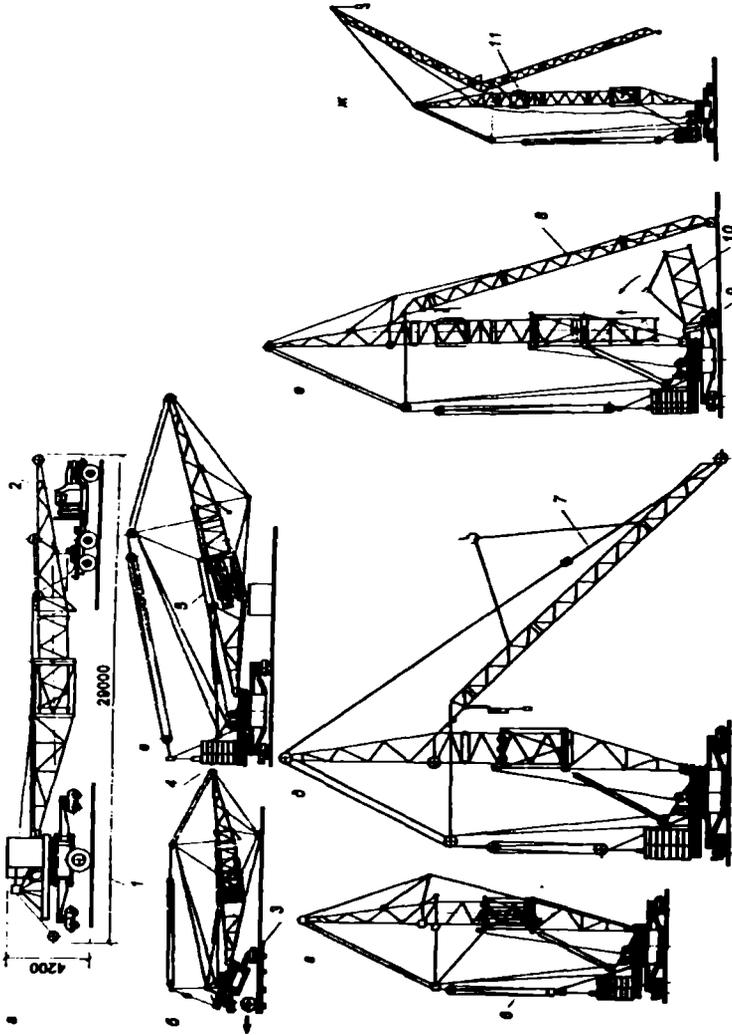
Монтаж башенного крана KB-403.1А:
